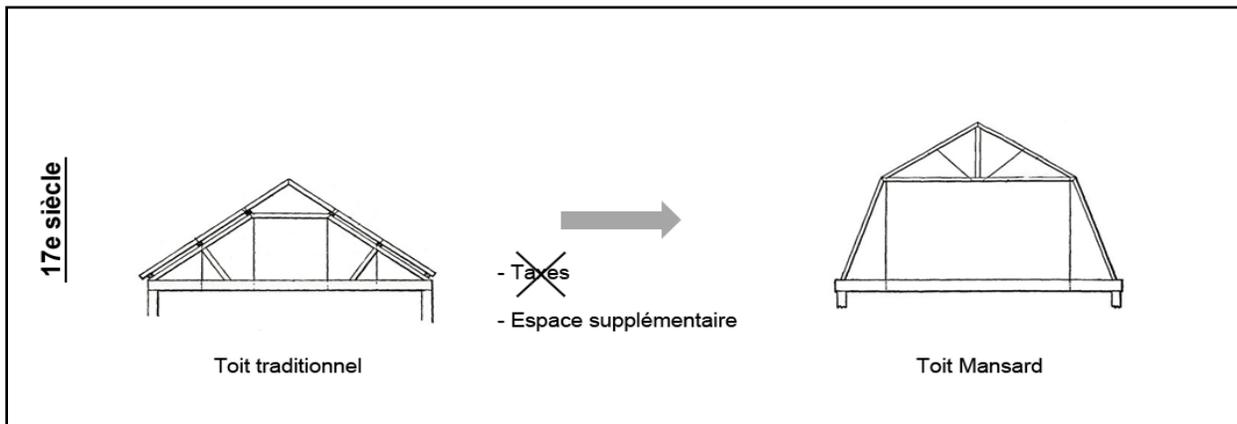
Évolution du toit traditionnel vers le toit Mansard
